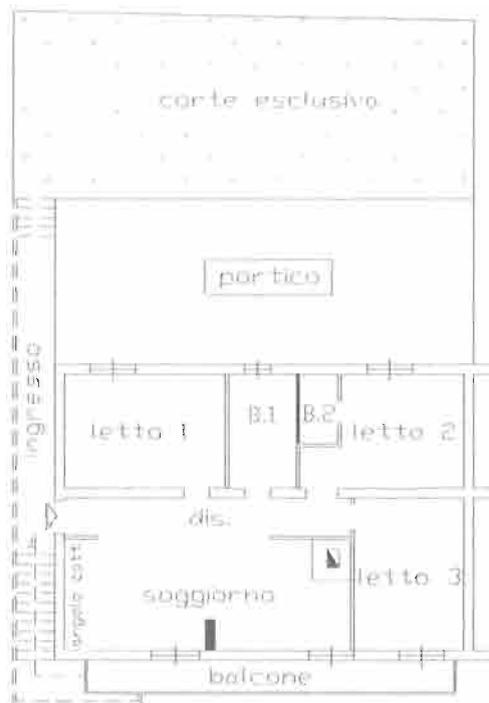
RILIEVO PLANIMETRICO (POST-OPERAM)
